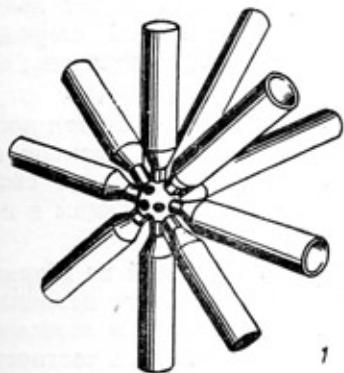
Леса трубчатой конструкции с болтовыми соединениями (система Меро)
